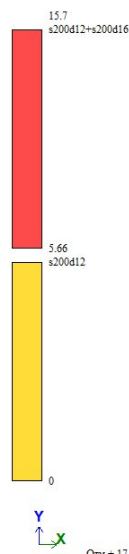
Нижня армування плити перекриття в ПК Ліра САПР
